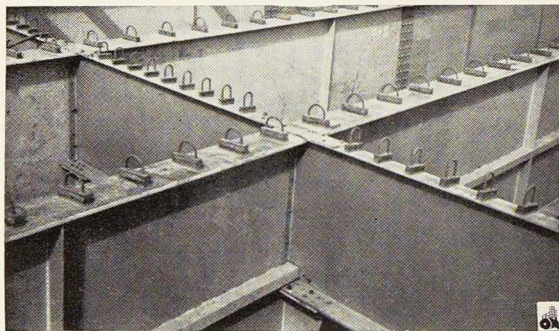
Croisement des maîtresses-poutres et des entretoises. Noter les anneaux pour le passage des câbles.
